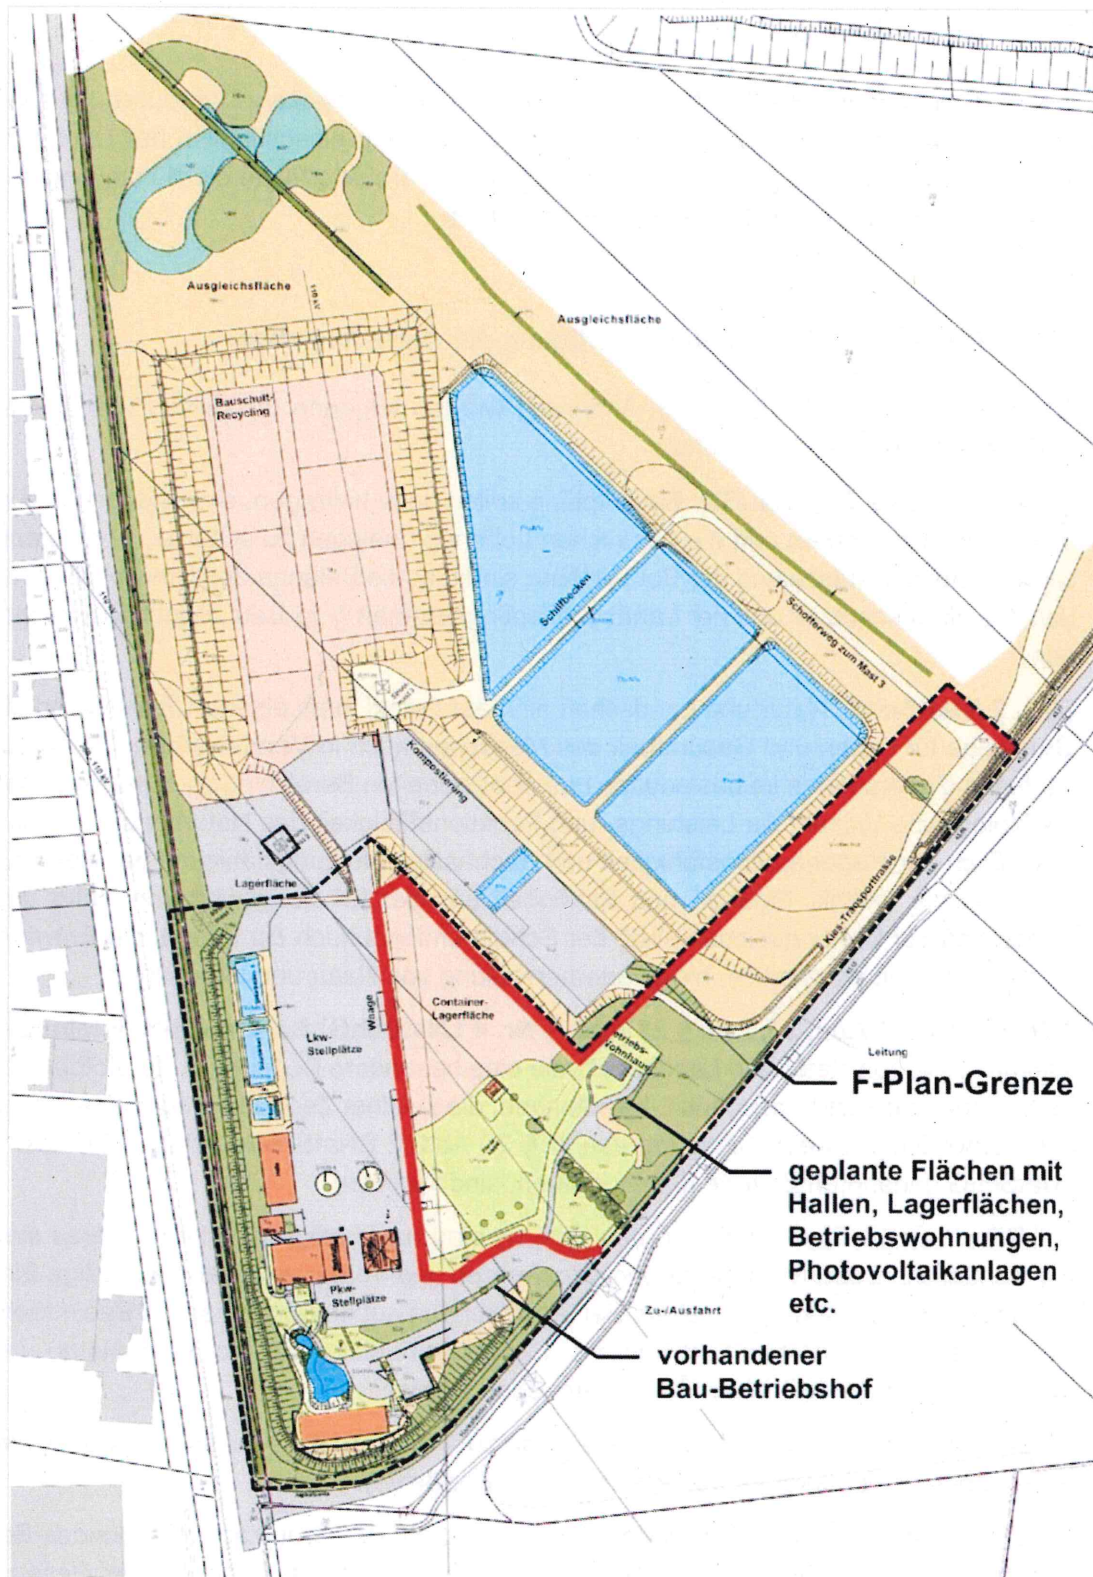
Plangeltungsbereich mit Darstellung Bestand und Planung
